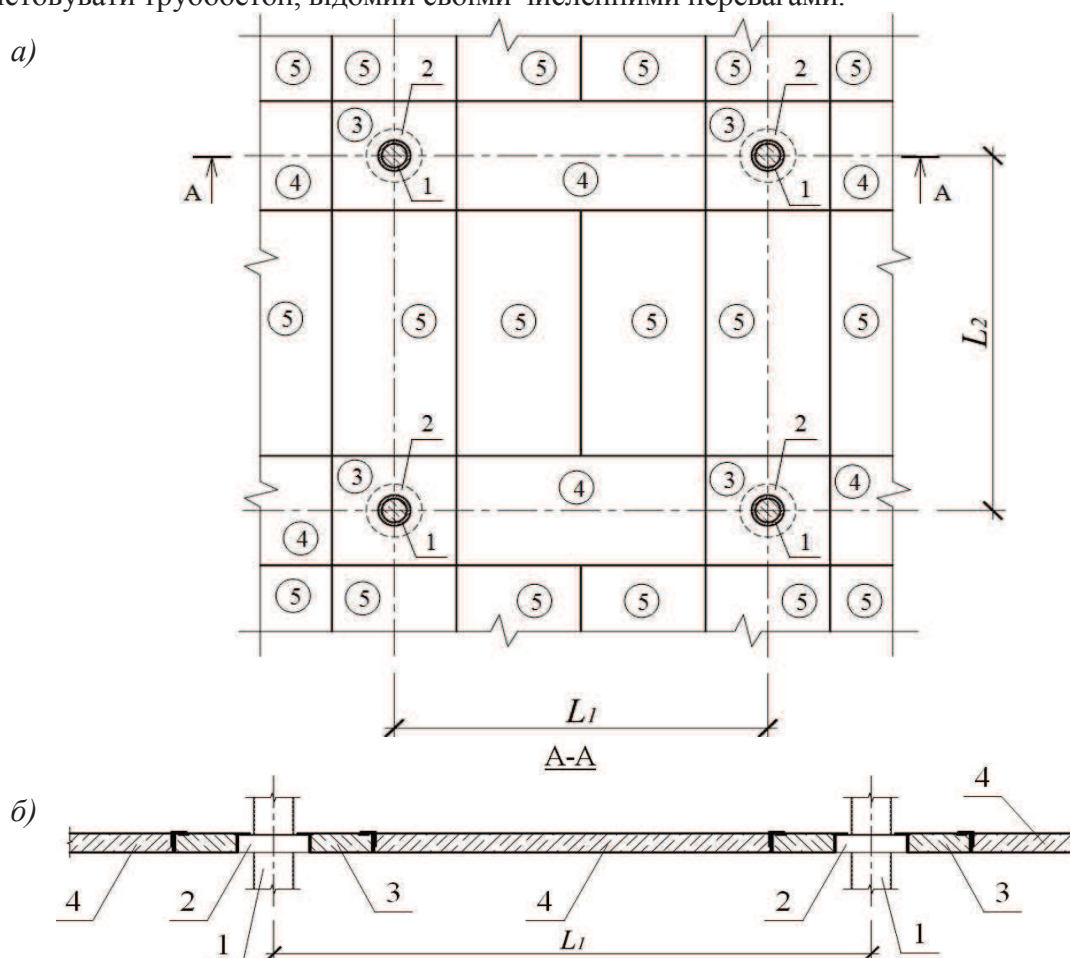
Схема збірного сталезалізобетонного безбалкового перекриття
